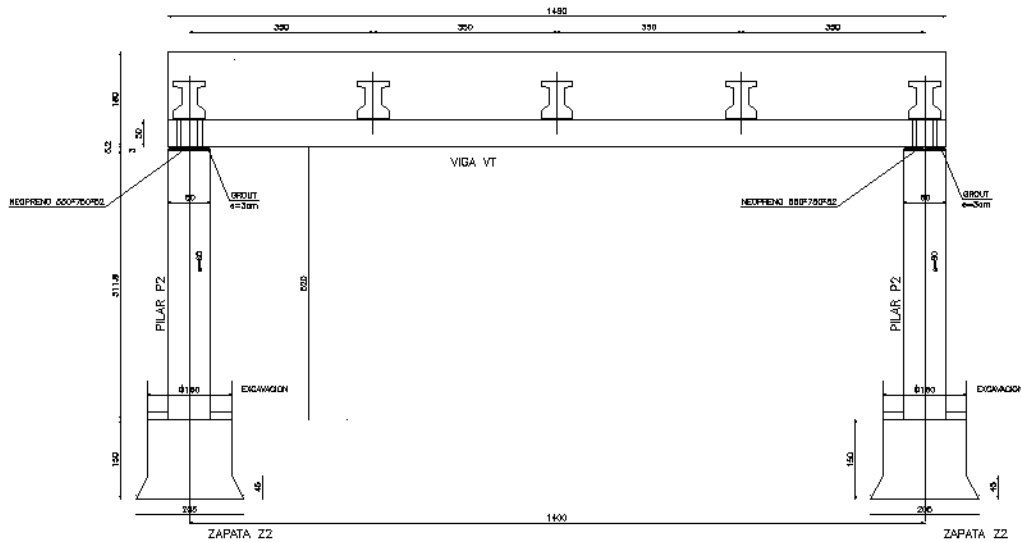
Corte por Eje Central, Sección Tipo TS-8.3
